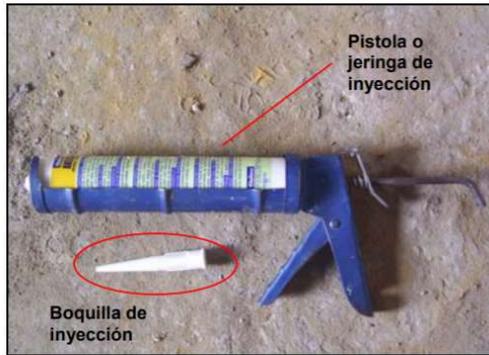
Herramientas utilizadas en la inyección de grietas con resina epóxica
